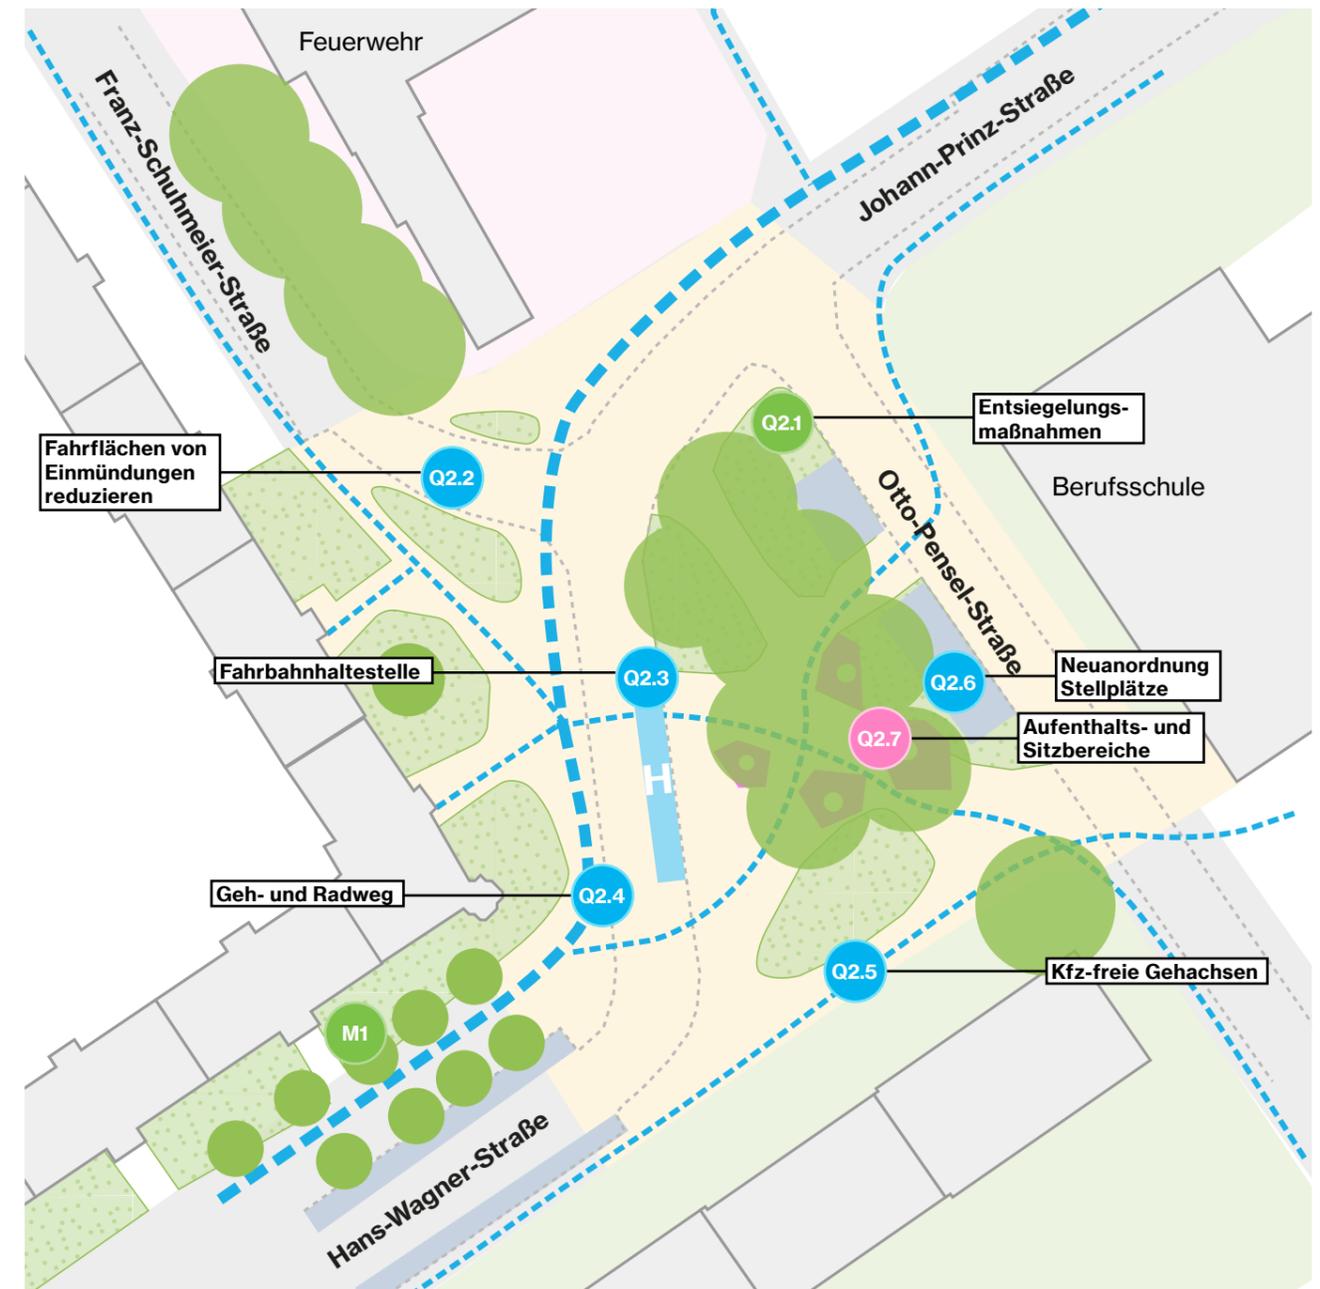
Detailplan Prototyp Schuhmeierplatz, Darstellung: Modul5
